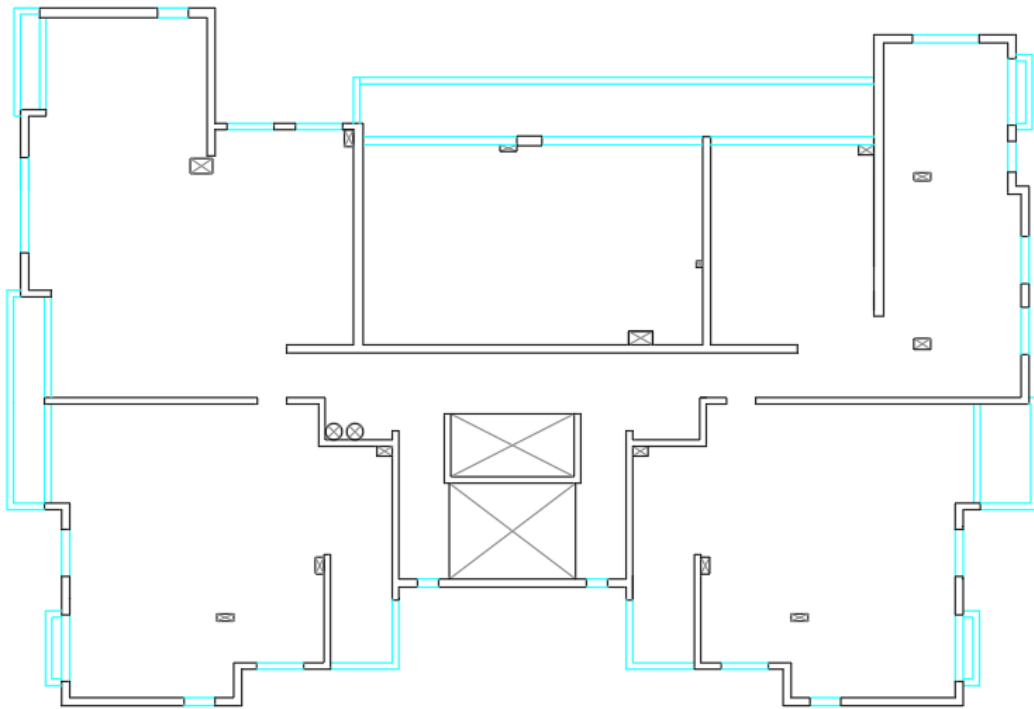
Adaptación de plano estructural de plantas de los pisos 3 al 5.
